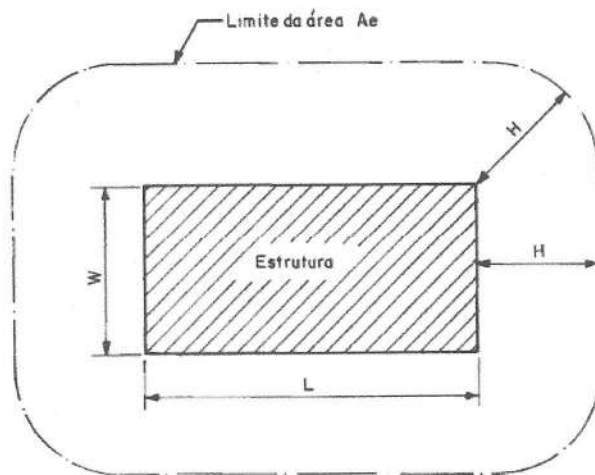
Delimitação da área de exposição equivalente ( $A_e$ ) - Estrutura vista de planta
